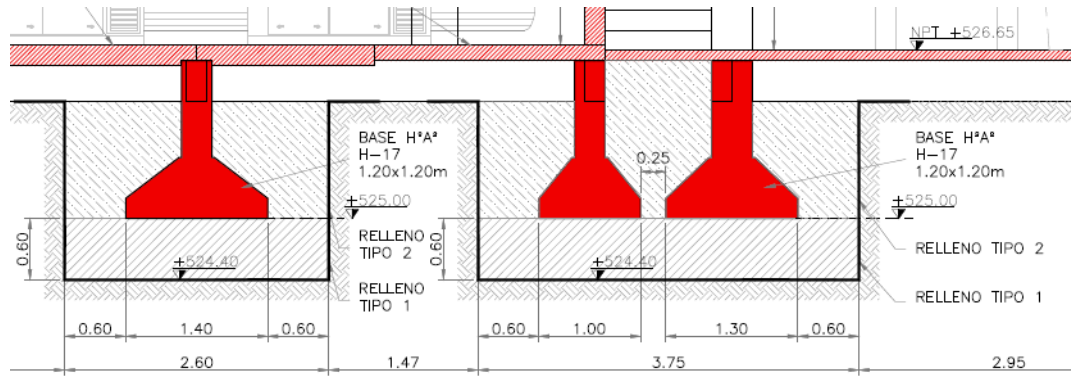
Rellenos de Excavaciones excedentes para estructuras
